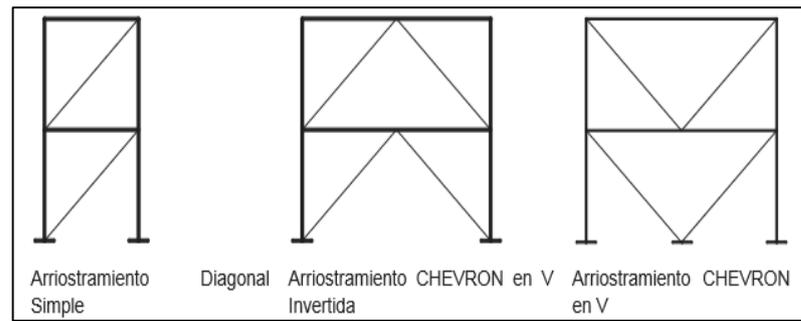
Pórticos arriostrados concéntricos 3 tipos
